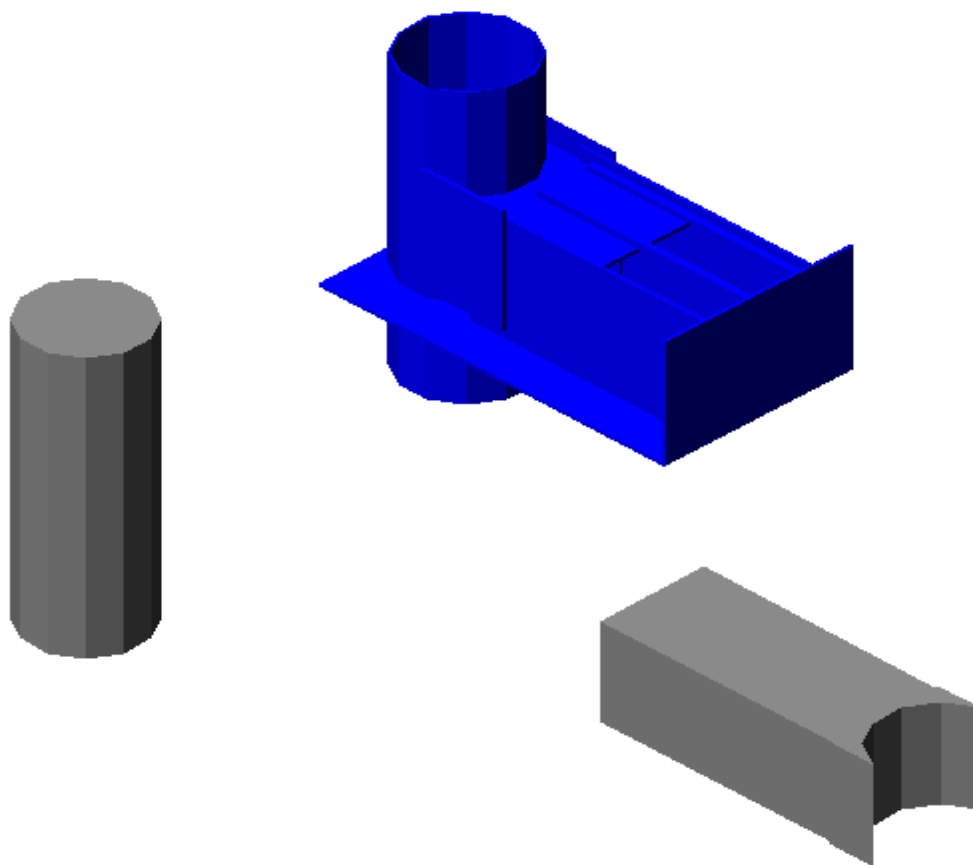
Об'ємна модель вузла та бетонні елементи
